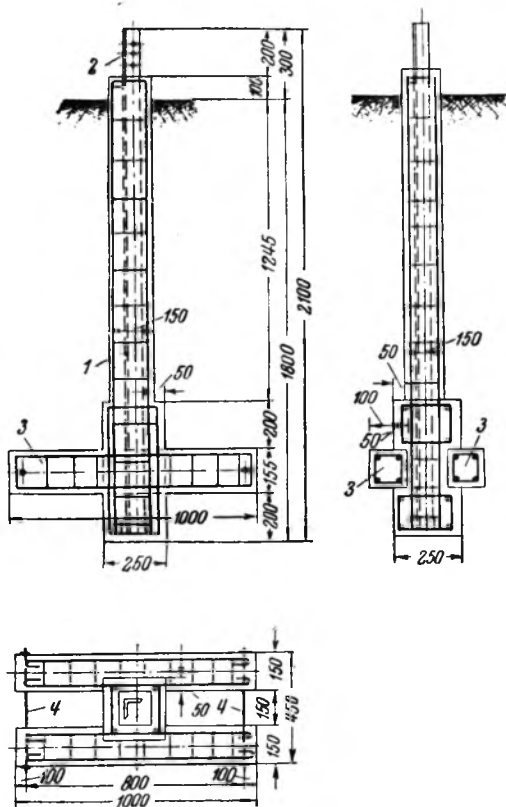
Новая железобетонная конструкция фундамента для промежуточных опор линий электропередачи.
